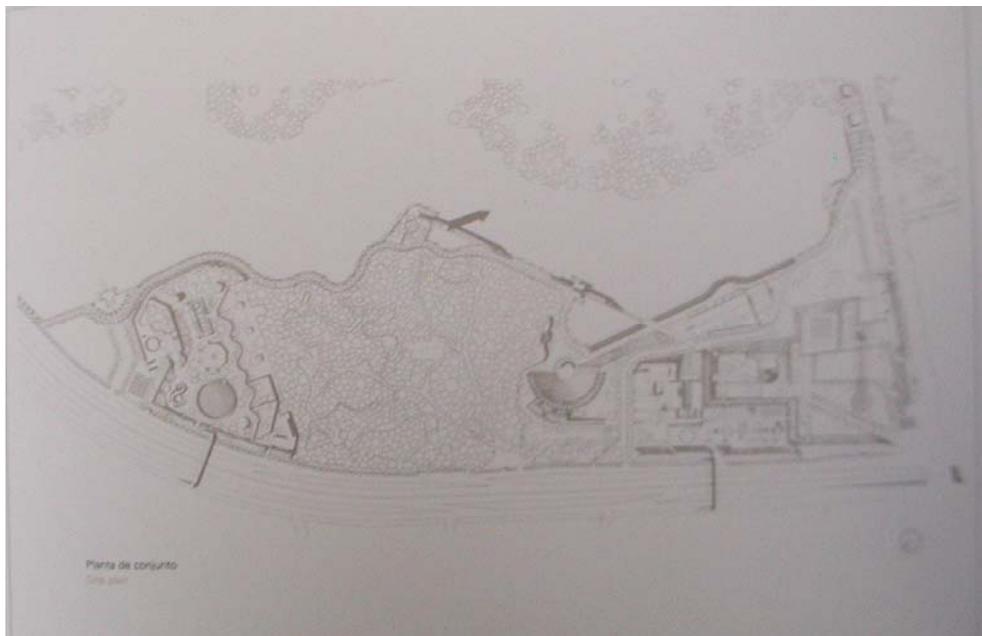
Planta de conjunto del Parque Garrido Canabal.
